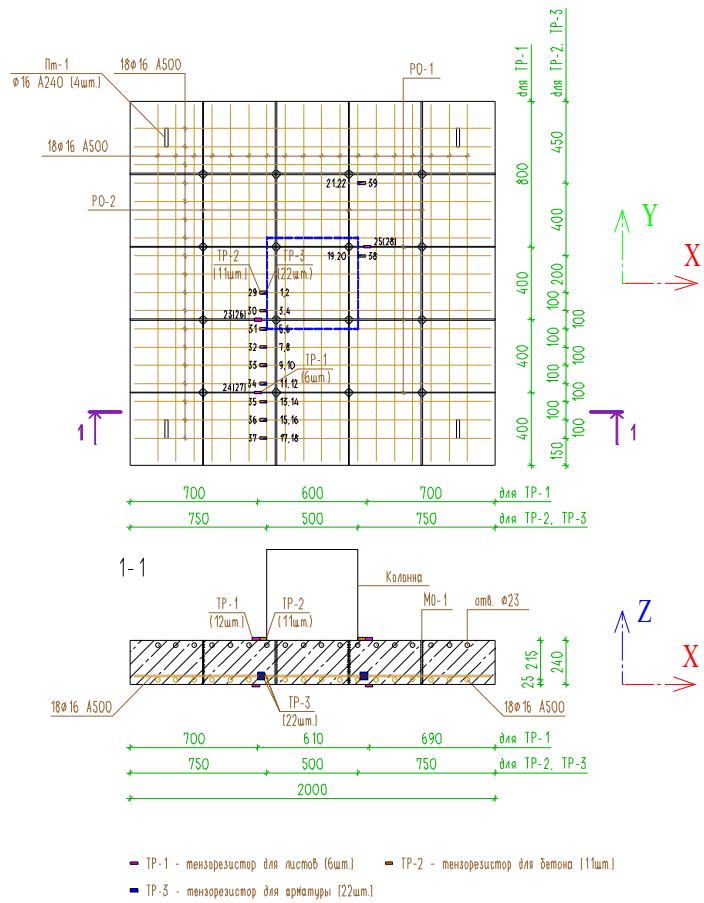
Фрагмент плиты перекрытия 4 (ФПП-4), РС64
